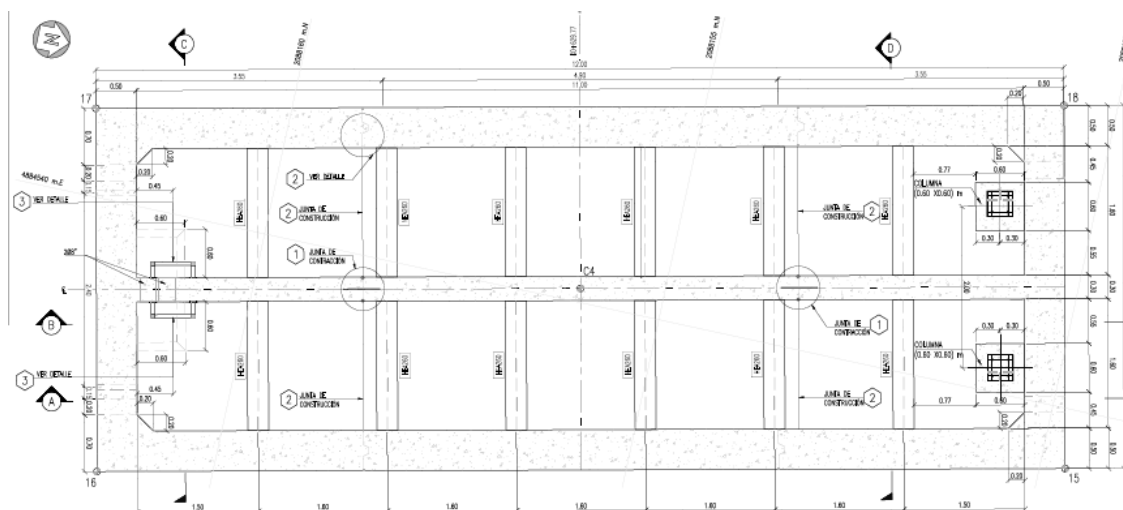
Dimensiones de la caja de apoyo de cercha CA1
